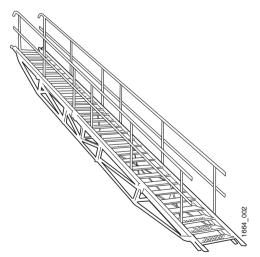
Viga Combi en combinación con escaleras Horisont largas (empalmadas)
